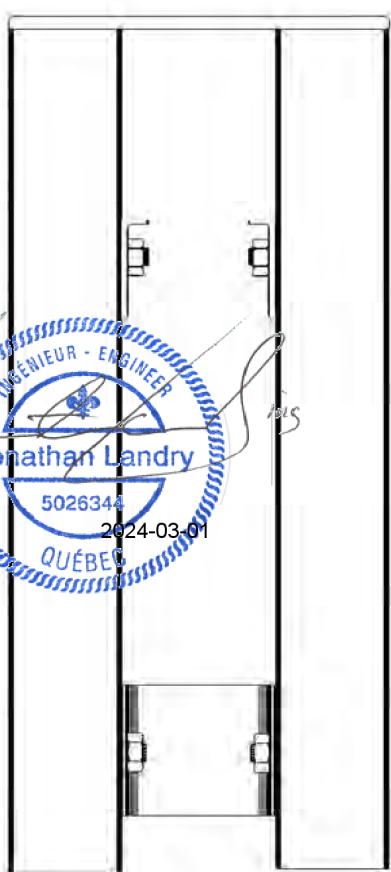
Le capuchon de poteau glisse vers le haut des poteaux.
